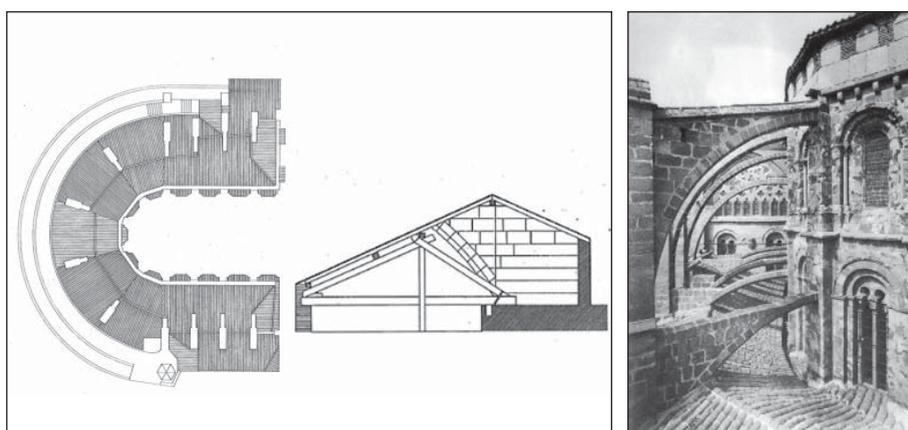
Detalle de planta y sección de la solución adoptada para la cubierta de la girola por Rodríguez Caro de la Rosa (Gómez-Moreno, 1900).
